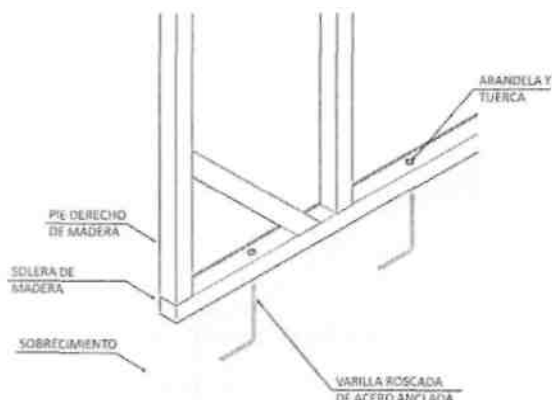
Detalle de uniones de paneles con estructuras de madera (semidura)
